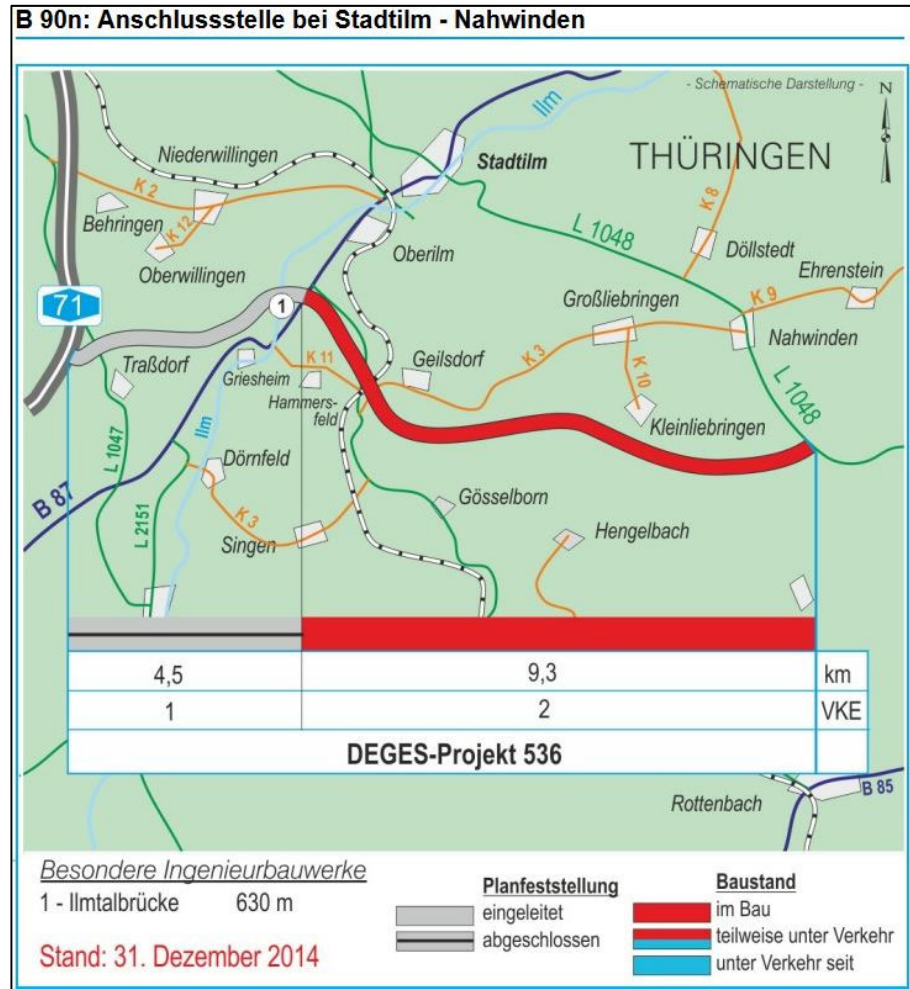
Nicht betrachteter Neubauabschnitt (DEGES)
